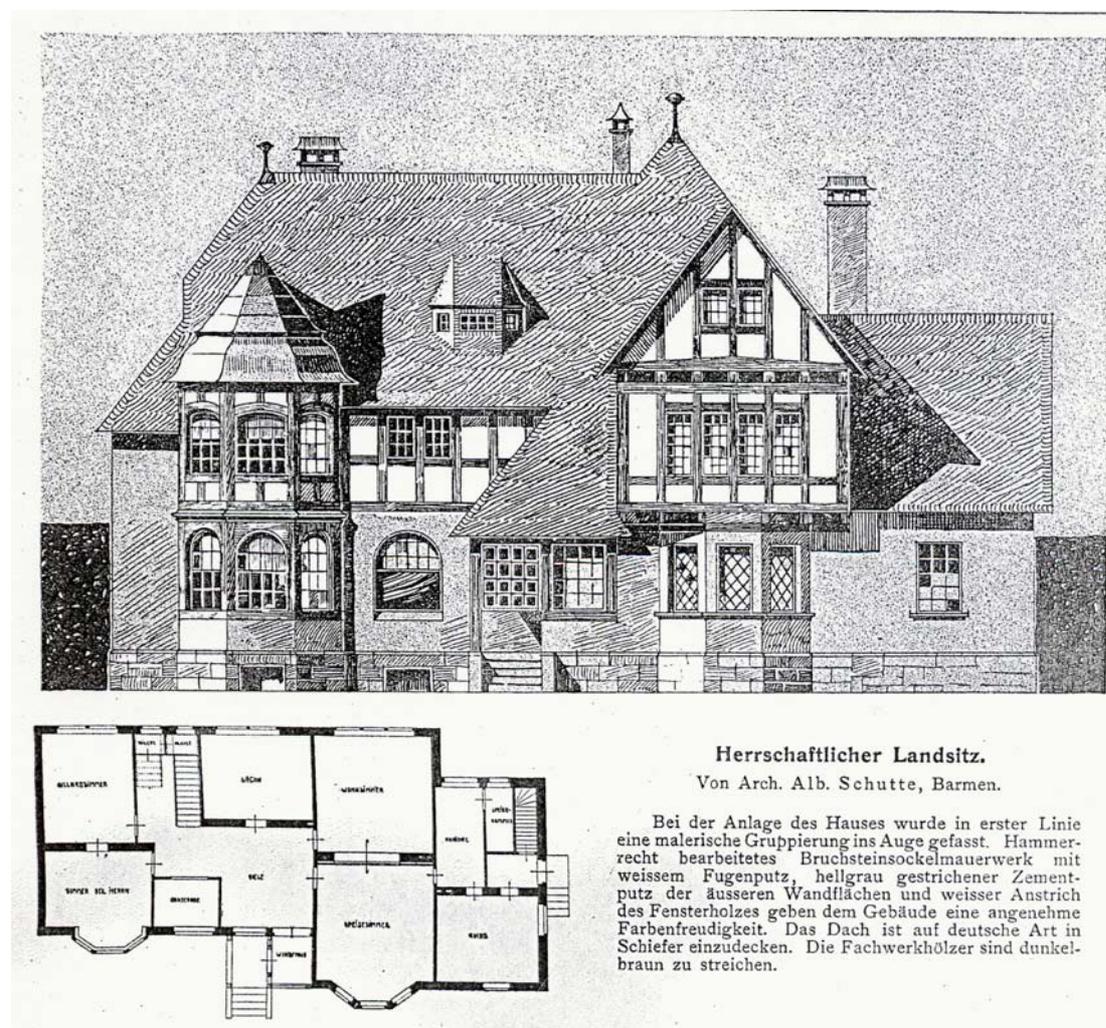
Albert Schutte, Barmen, Herrschaftlicher Landsitz, Aufriss und Grundriss 1904
